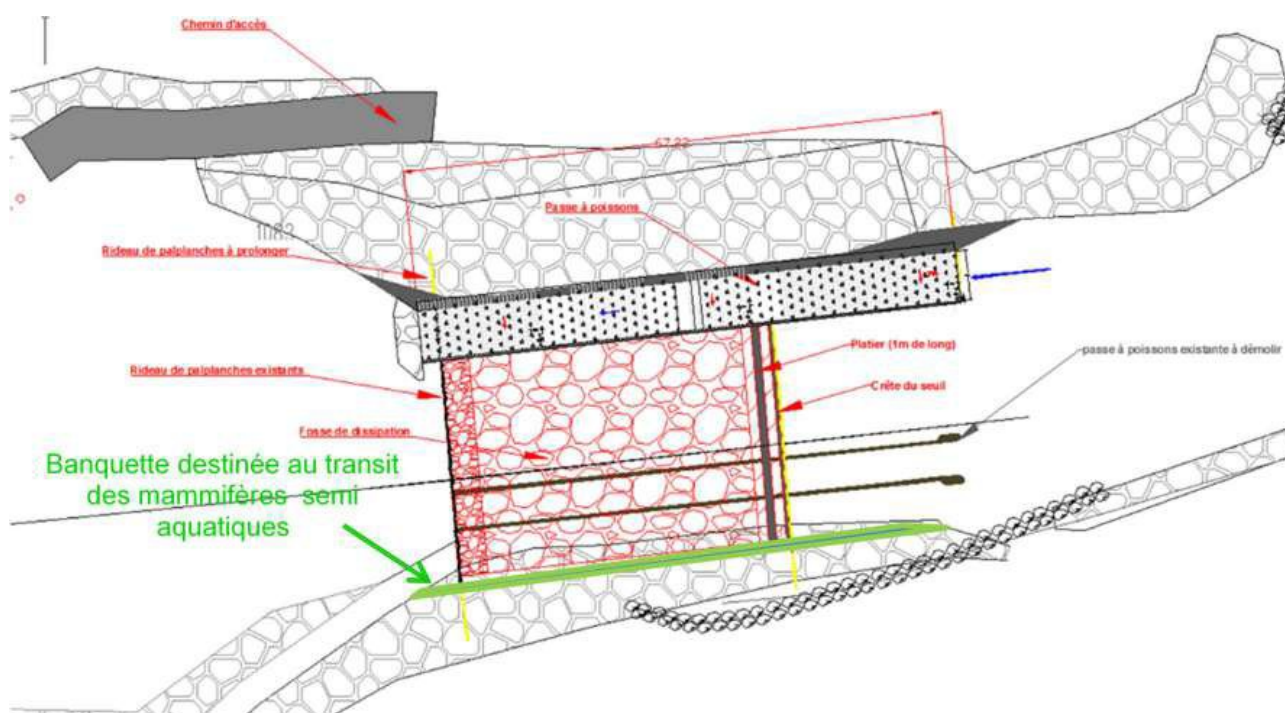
Vue en plan de l'implantation de la passe à poissons et du seuil – Source : Dossier technique de demande
